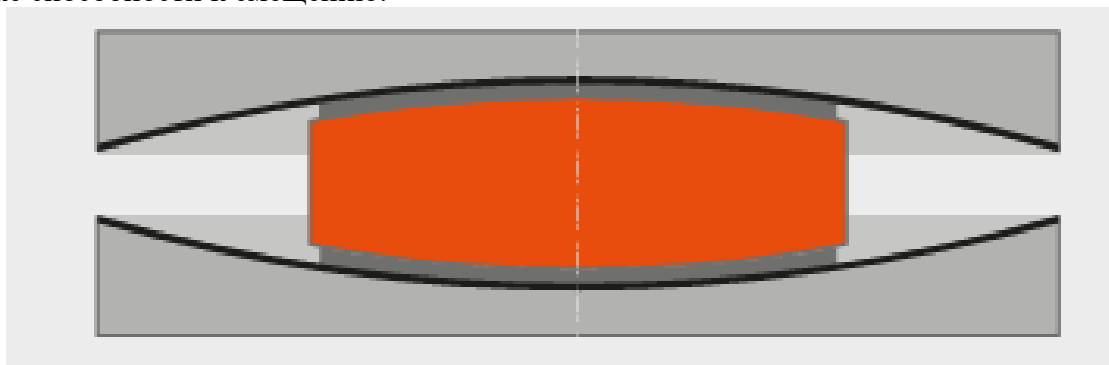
Схема в разрезе двойного скользящего маятникового изолятора с восстановлением положения. [19]
